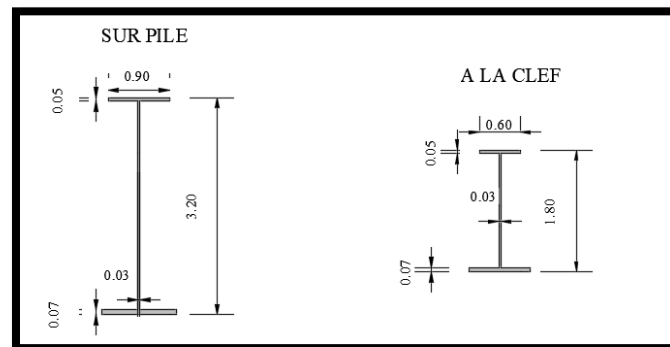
Coupe transversale des poutres principales de la variante N°2.
